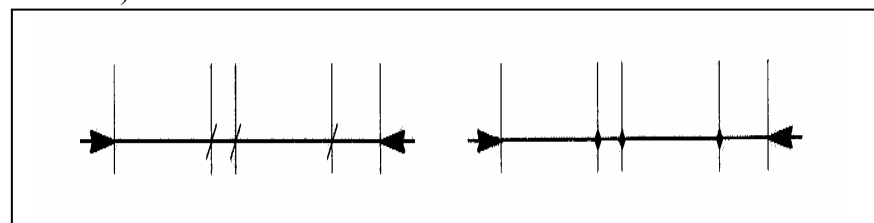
Простановка размеров между смежными элементами (цепочкой)
